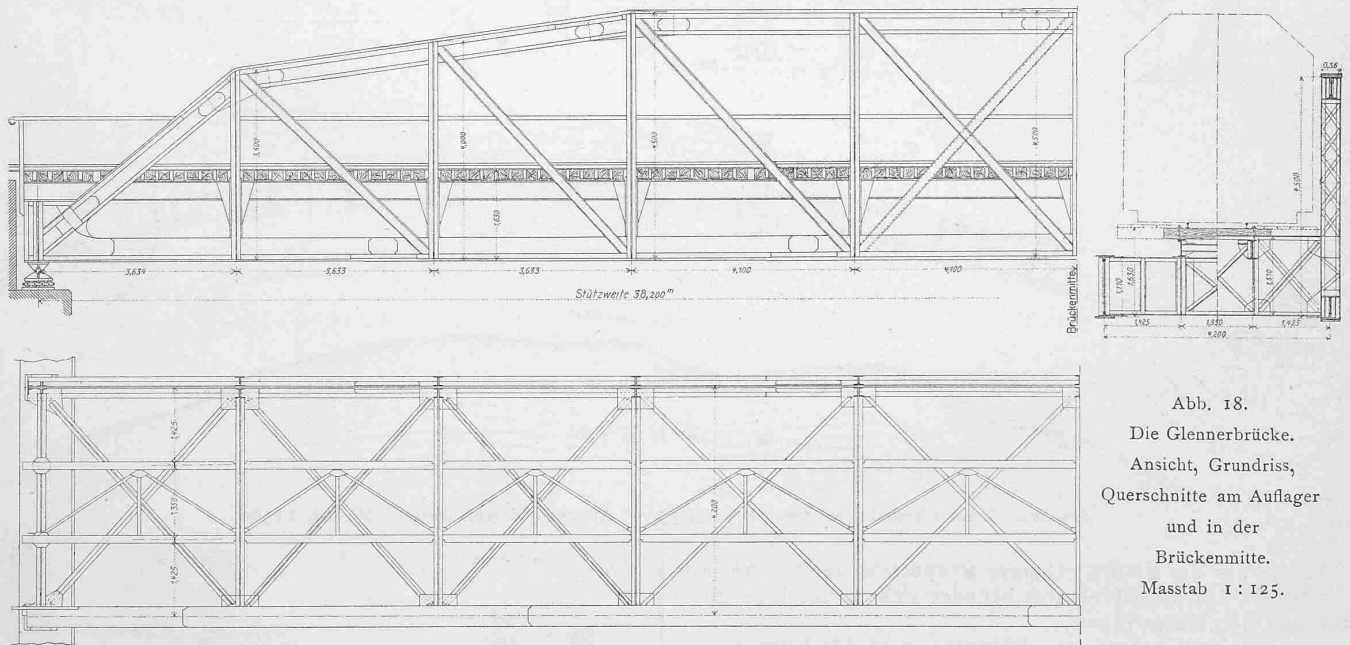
Die Glenerbrücke. Ansicht, Grundriss, Querschnitte am Auflager und in der Brückenmitte. Masstab 1:125.
